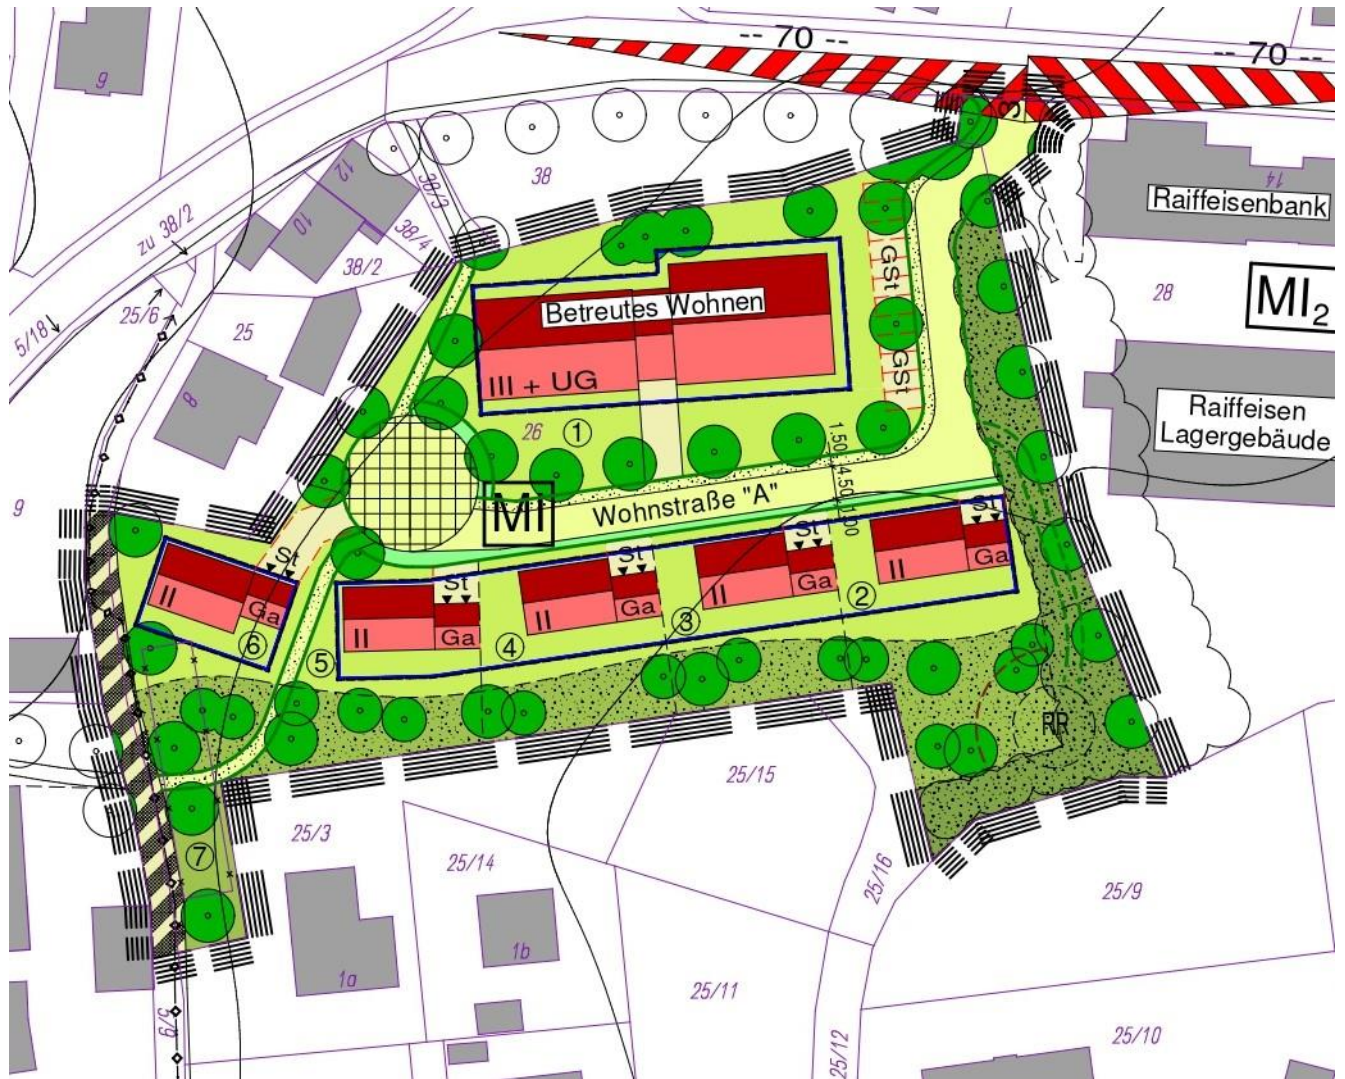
Plandarstellung des „MU Tiefenbach Mitte“ M 1/1000
